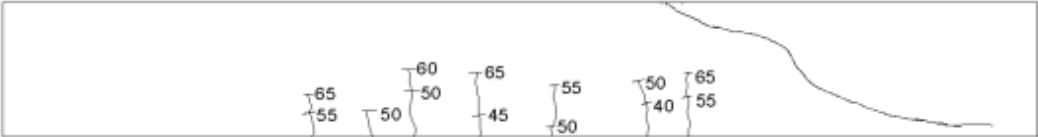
Mapa de fissuras da Viga V3P075
